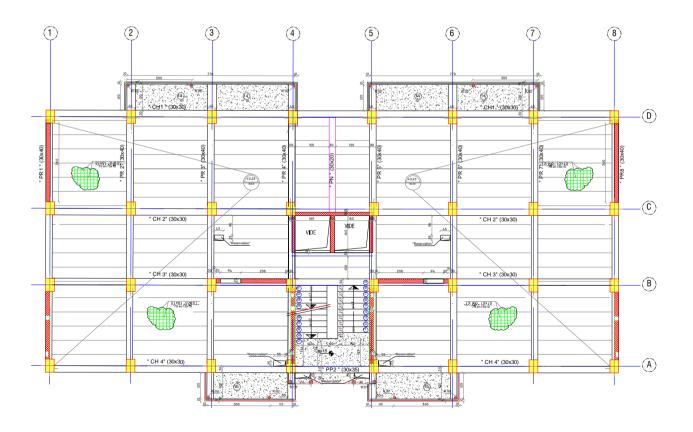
Plan de coffrages (Disposition des poutrelles).
